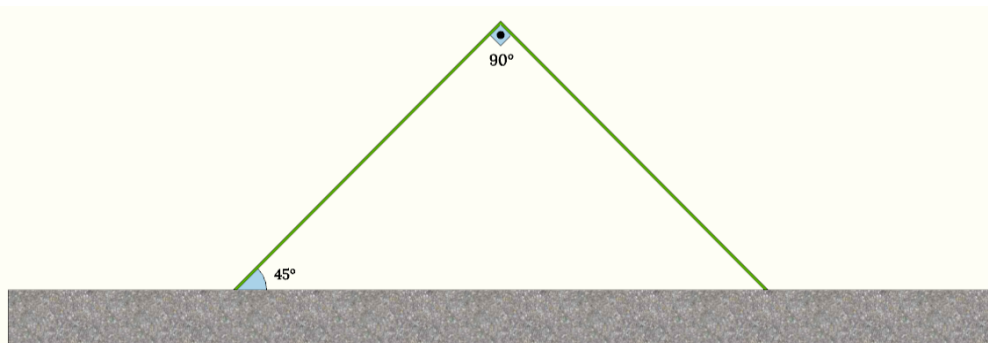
Instalação de placa angular em parede ou pilar (vista superior)
